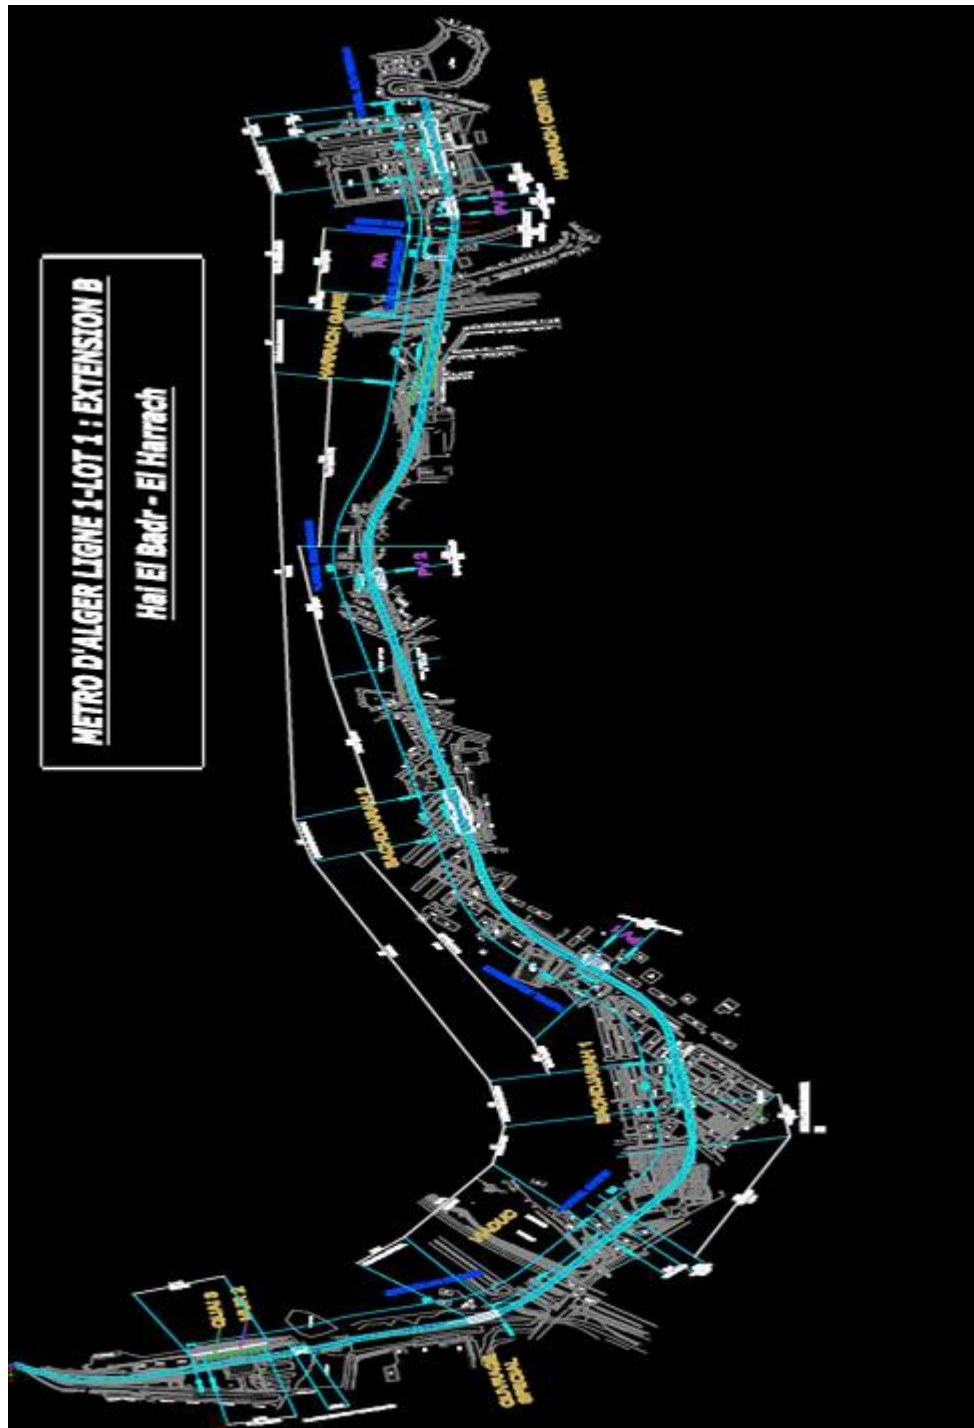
Plan de l'extension B : HAI EL BADR –EL HARRACH. (Omrani K et Boutria H, 2012)
